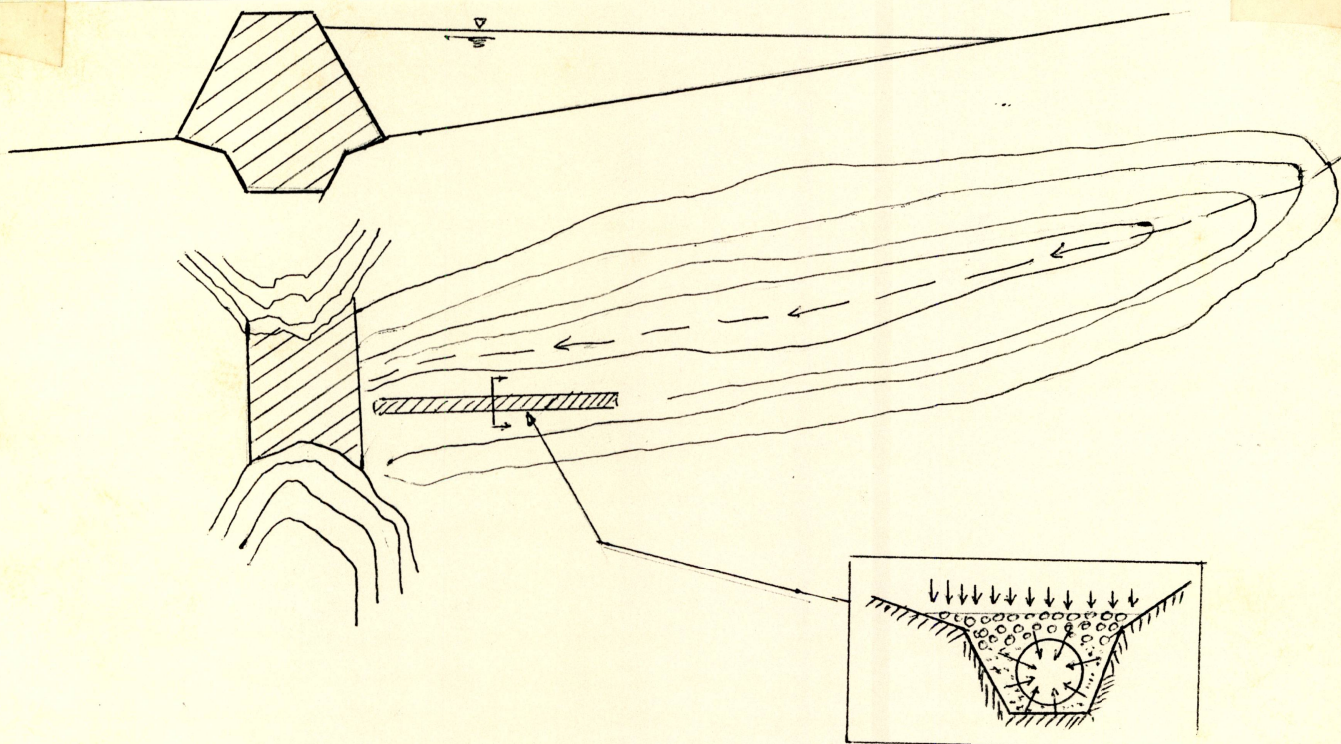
FIG C. Sección Longitudinal y en Planta del Embalse con indicación de la Fosa de Infiltración.
